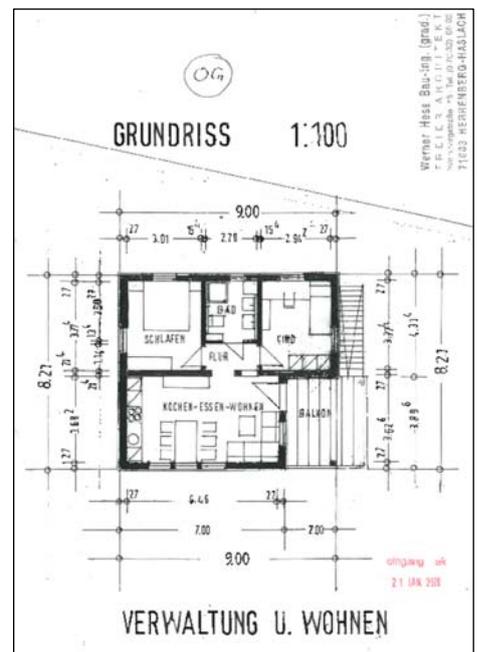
Grundriss OG – Verwaltung/Wohnen
